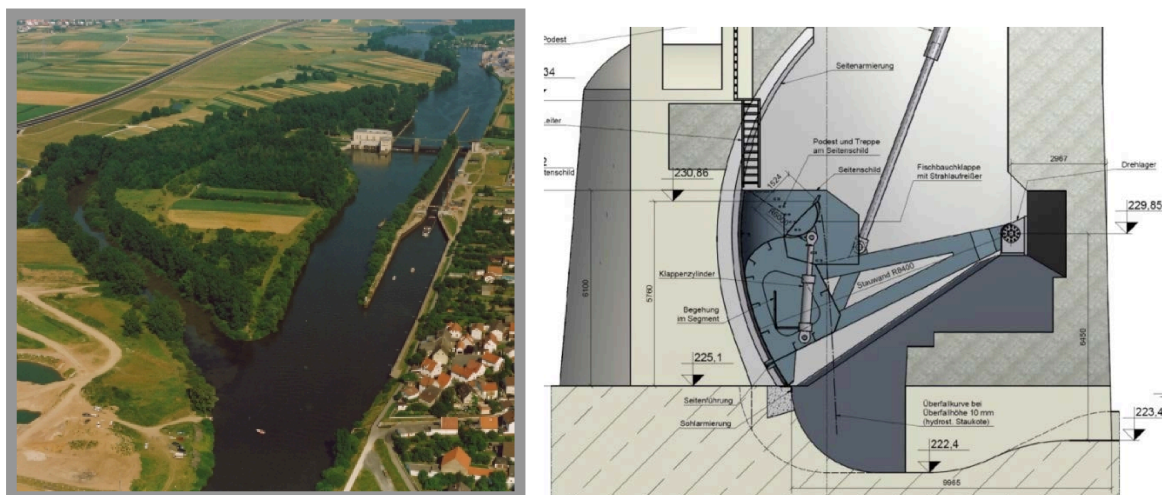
Staustufe Viereth und Planung Drucksegment mit Klappe
